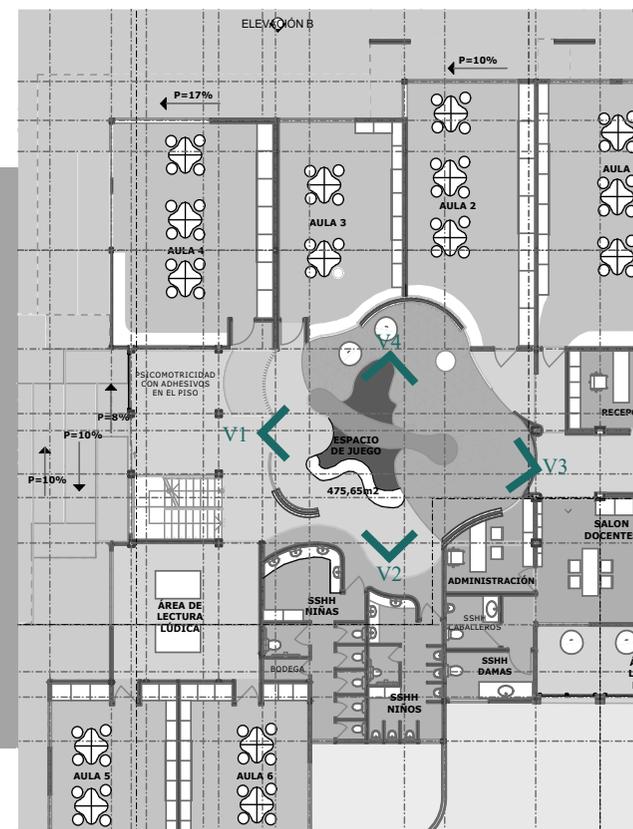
Planta de vistas de la plaza central. Fuente: Autora.
